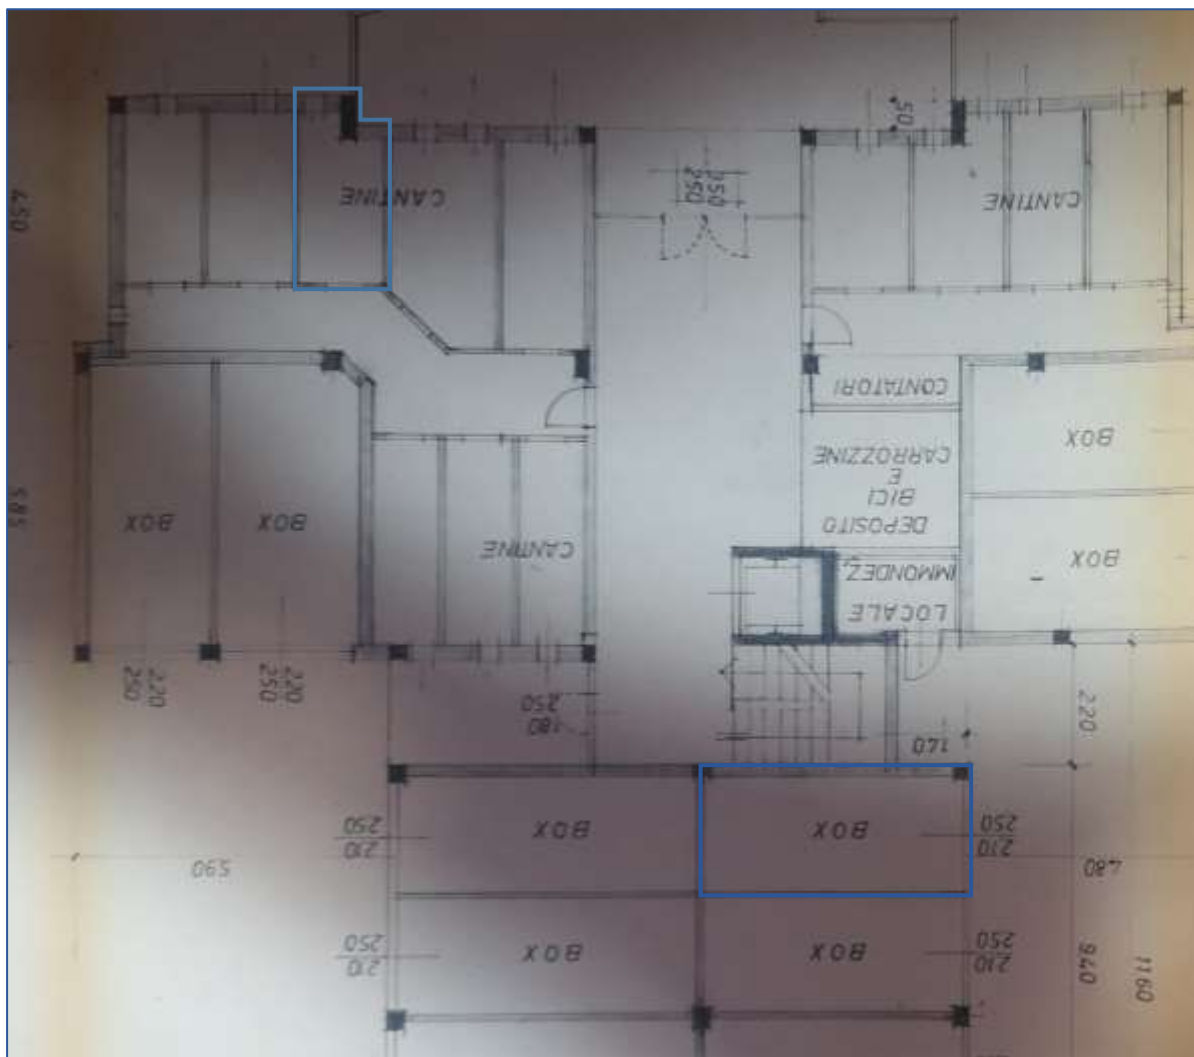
Estratto tavola di progetto piano terra con l'indicazione del box e della cantina
